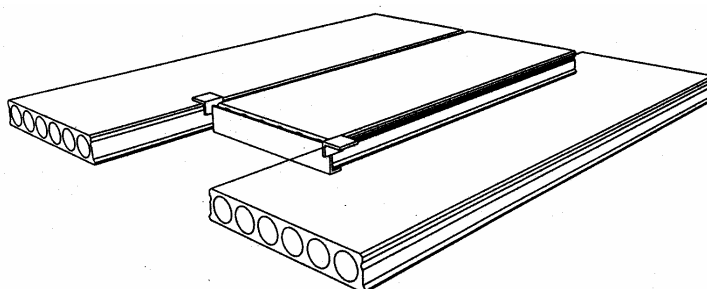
utilização de dispositivos de apoio indireto com cantoneiras ou vigas para grandes aberturas
